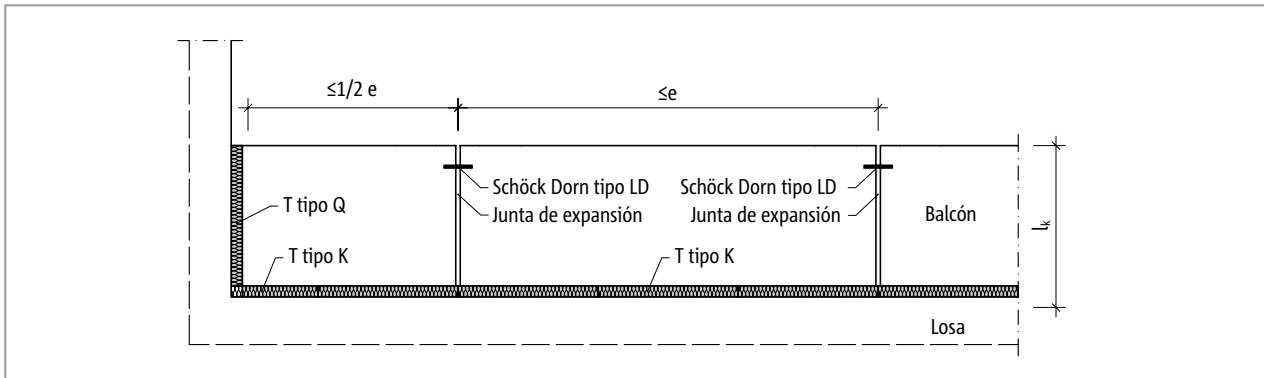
Schöck Isokorb® T tipo K: Disposición de las juntas de expansión
